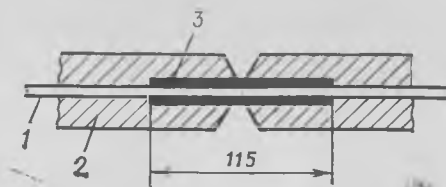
Линейный шарнир с пластической сталеполимерной связью
